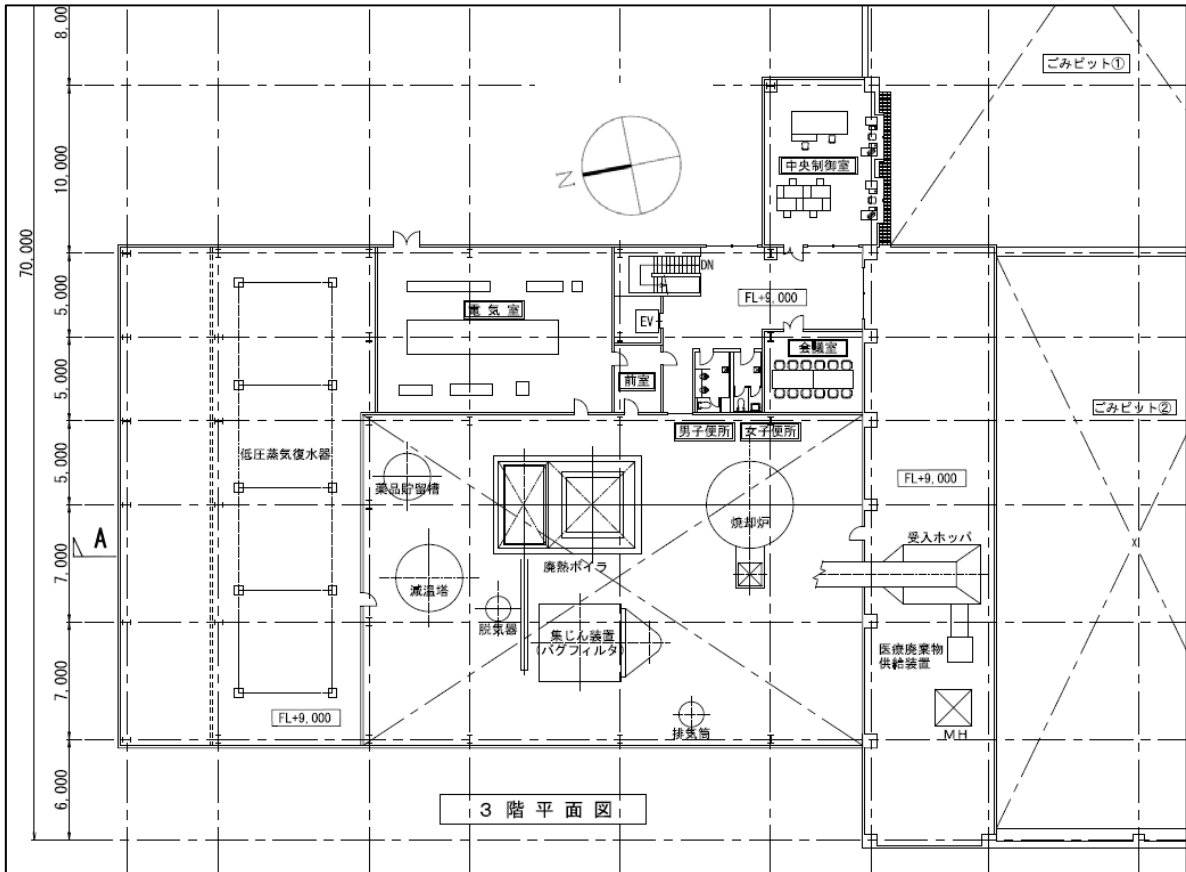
(3) 設備配置図 (焼却施設 3階)
